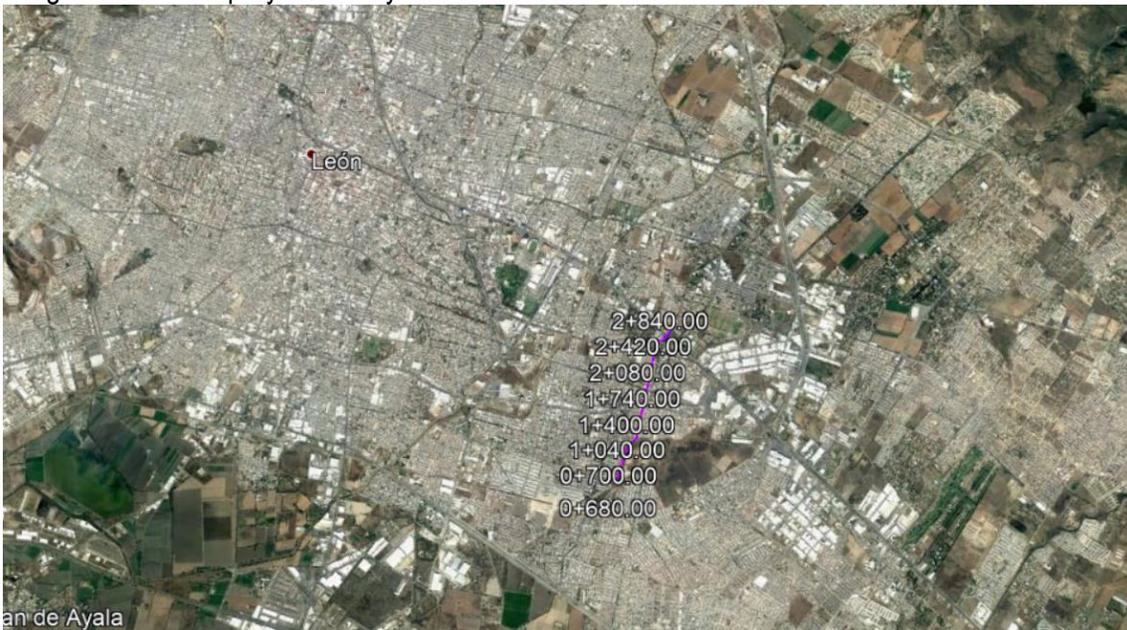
Zona del proyecto en el Arroyo Las Liebres.
